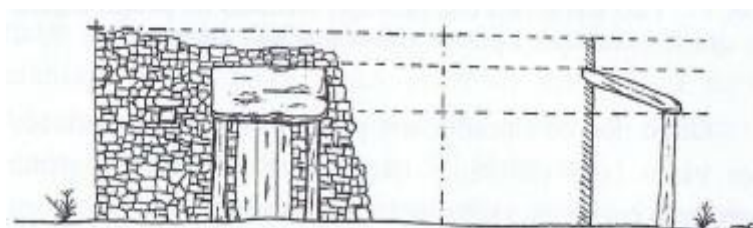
Casa alpendrada com duas lajes colocadas em posição angular que se encostavam à parede
